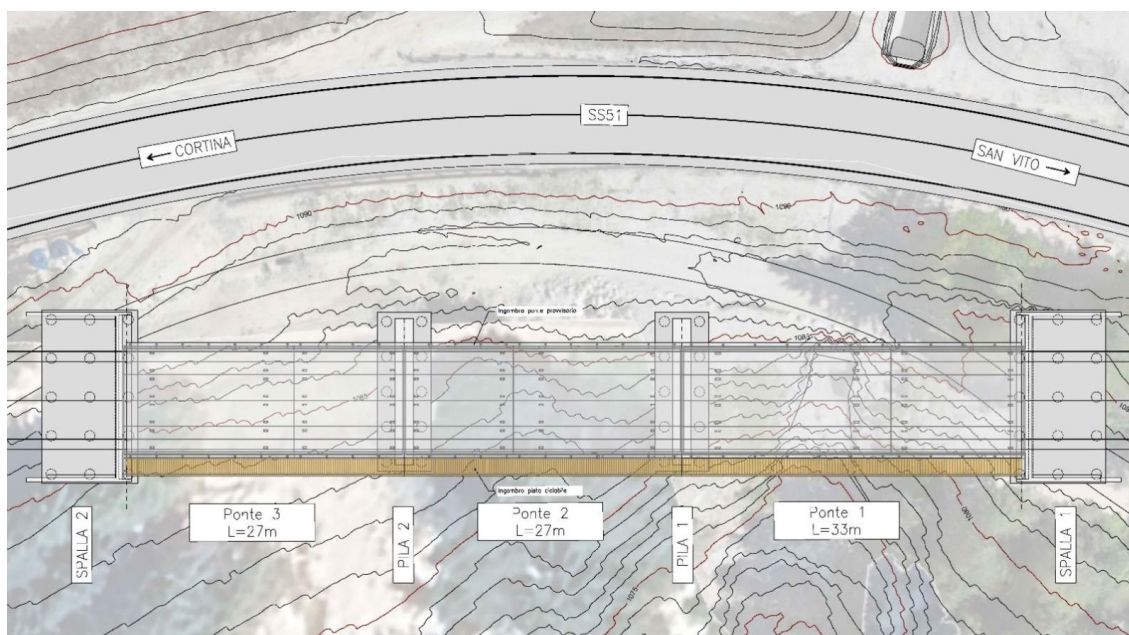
PLANIMETRIA PONTE PROVVISORIO
